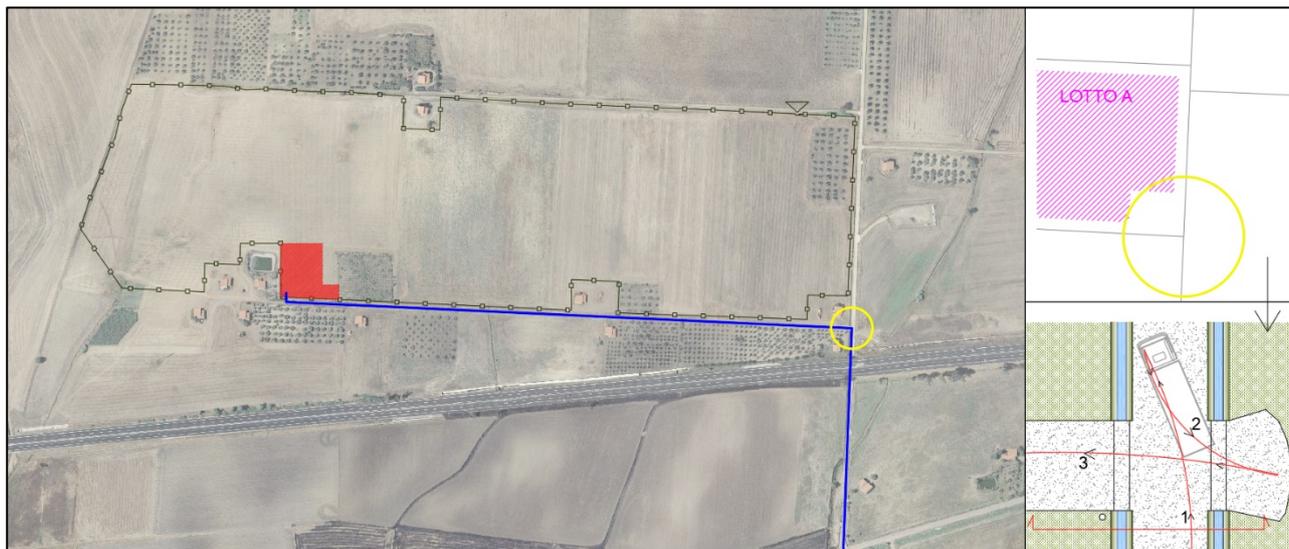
Planimetria su Ortofoto, Indicazione Accesso al Cantiere
